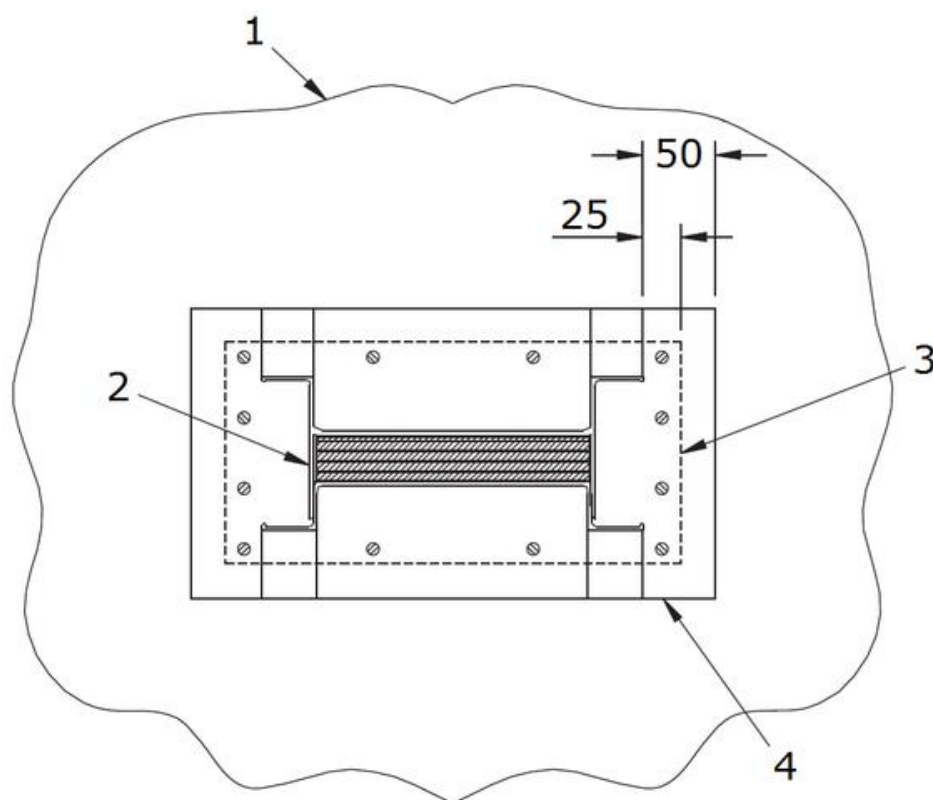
Схема выполнения проходки шинпровода через стену: 1 – стена или другое вертикальное перекрытие; 2 – шинпровод; 3 – отверстие в стене; 4 – пластина для закрытия зазора между шинпроводом и стеной.
